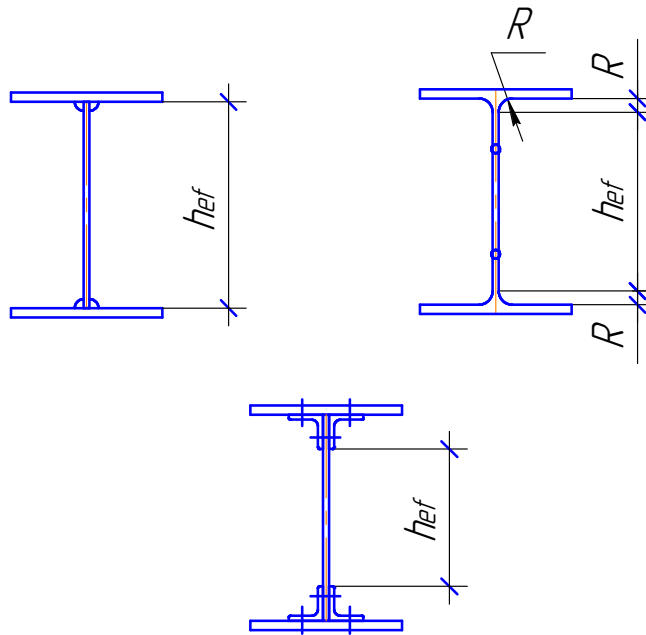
Расчетная высота стенки h_{ef} для балок составного сечения
